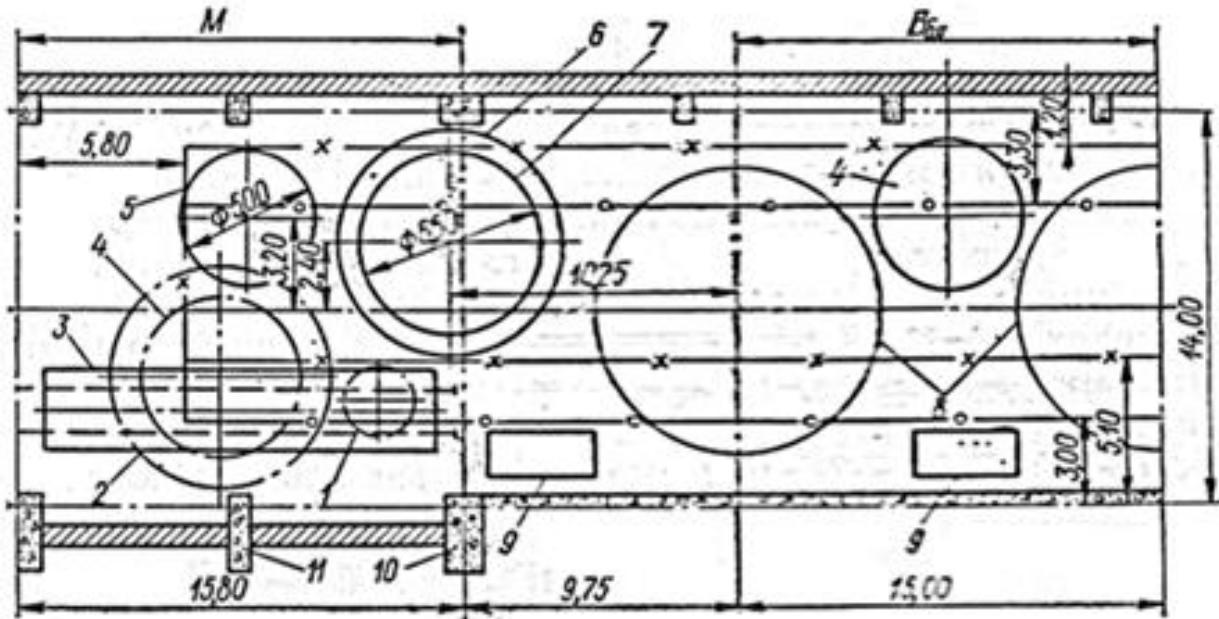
Поперечний переріз будівлі пригребельної гідроелектростанції
